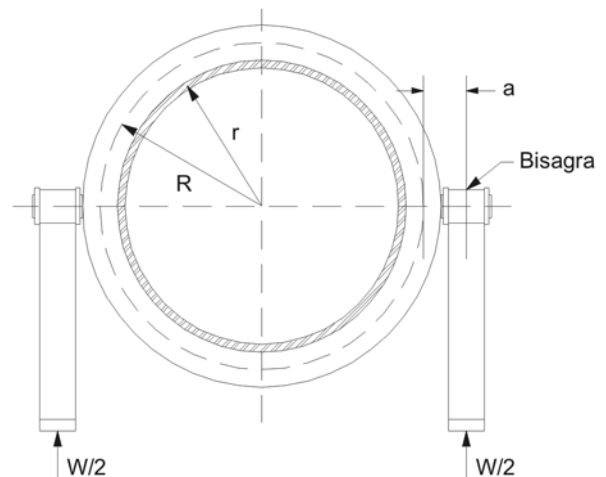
Detalles del apoyo anillo-viga con bisagras en la unión de las columnas.
